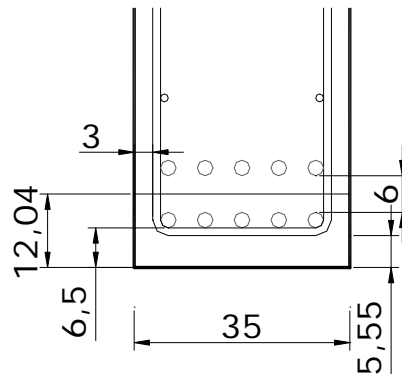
Detalle de la ubicación del refuerzo longitudinal por flexión
